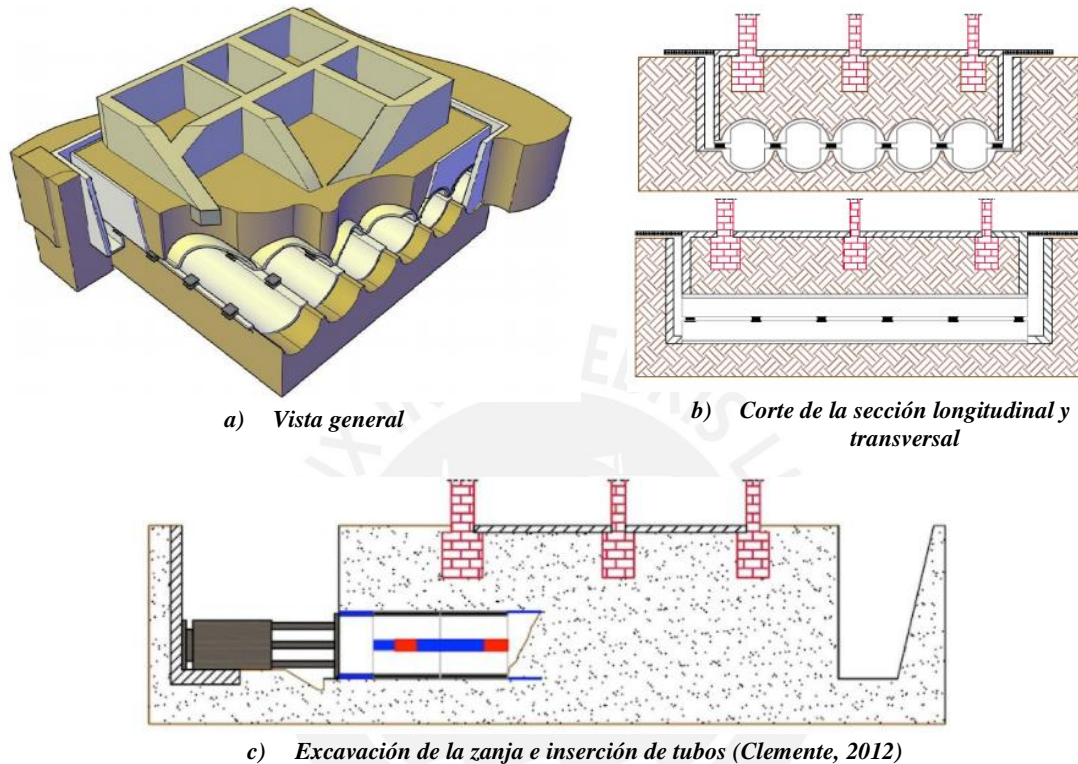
Nuevo sistema de reforzamiento con aisladores
